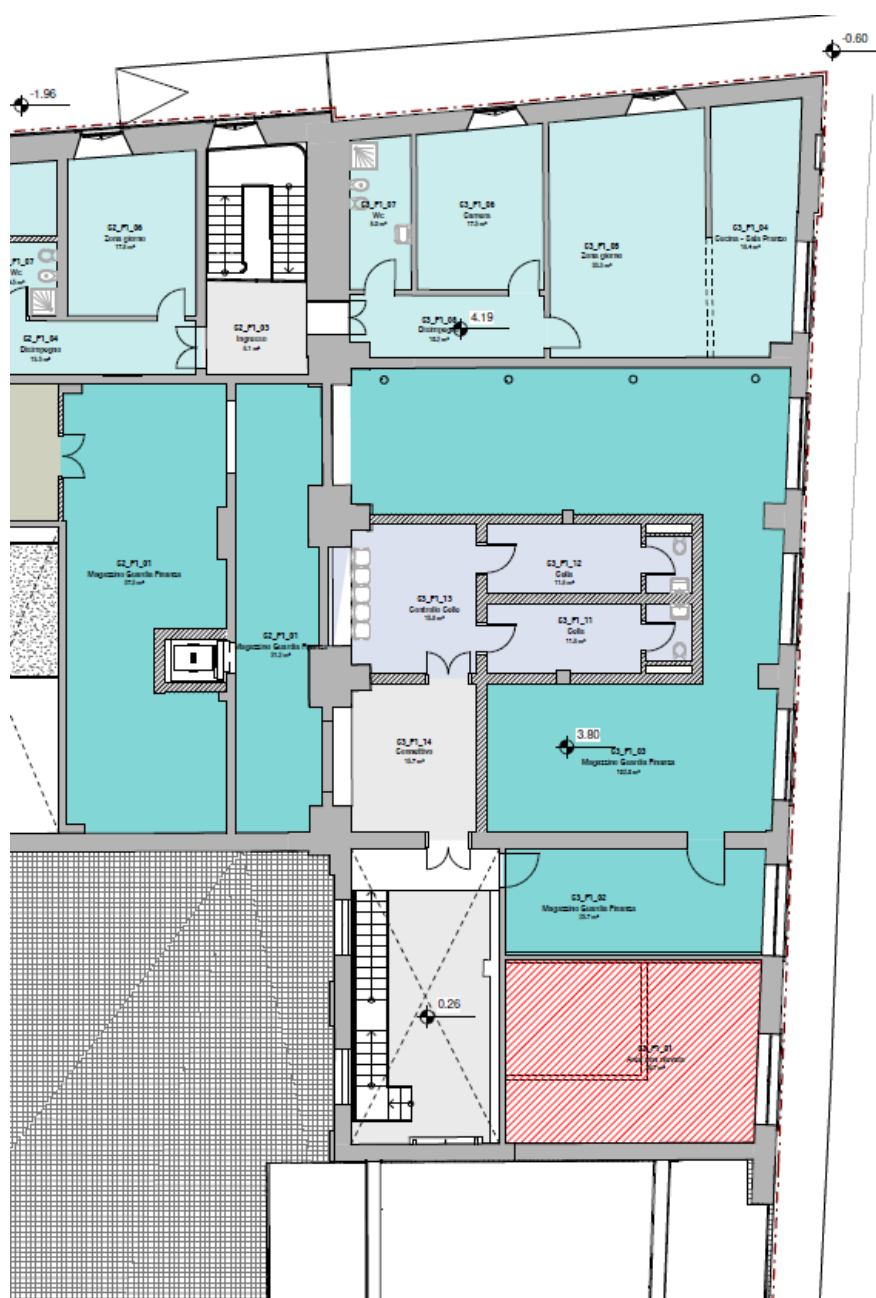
Edificio C3, pianta piano primo – estratto della pianta con le indicazioni funzionali
